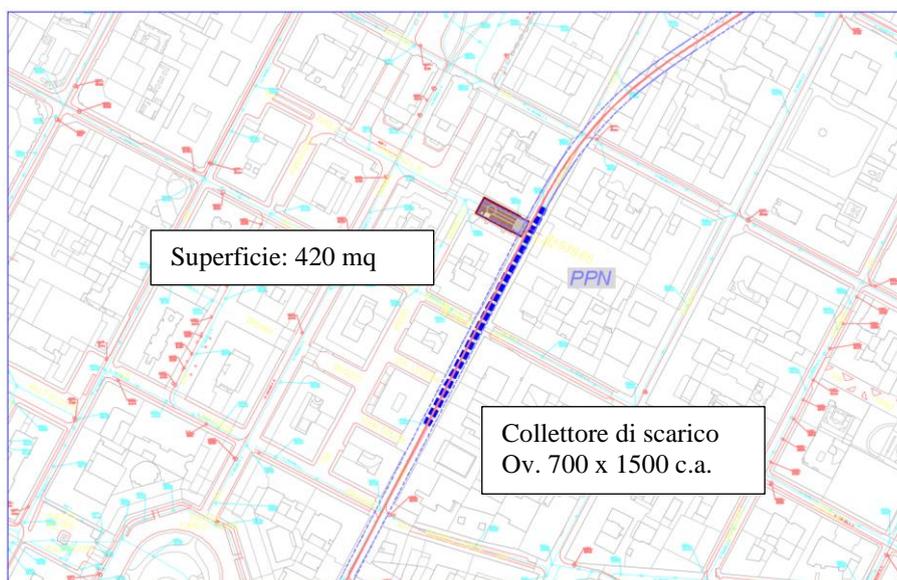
Aree di cantiere – Pozzo PPN – FASE UNICA
